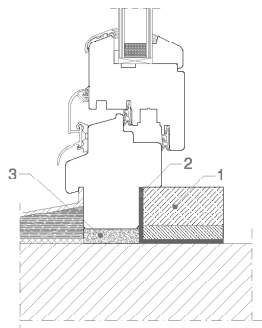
Sposób montażu parapetu zewnętrznego na drewnianym oknie:
